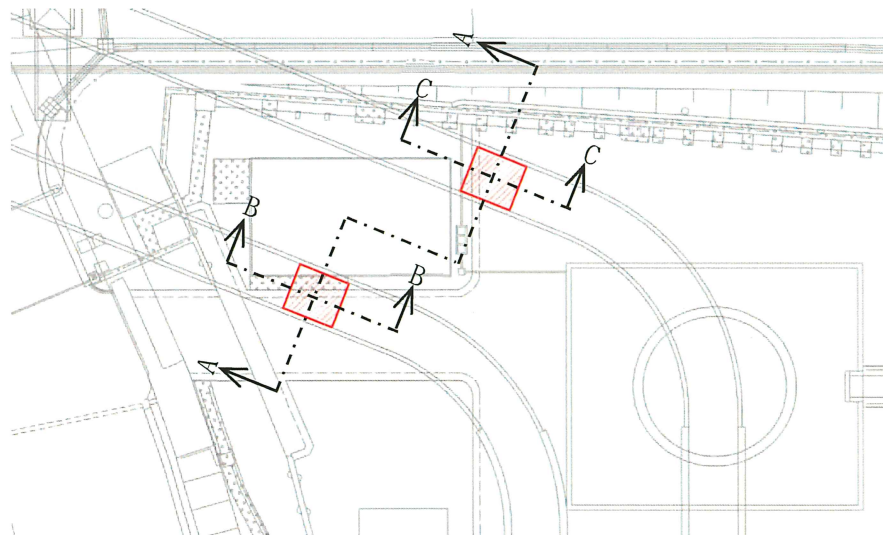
(1) 取放水路流路縮小工（第1号機取水路）(No. 1), (No. 2) 平面図
